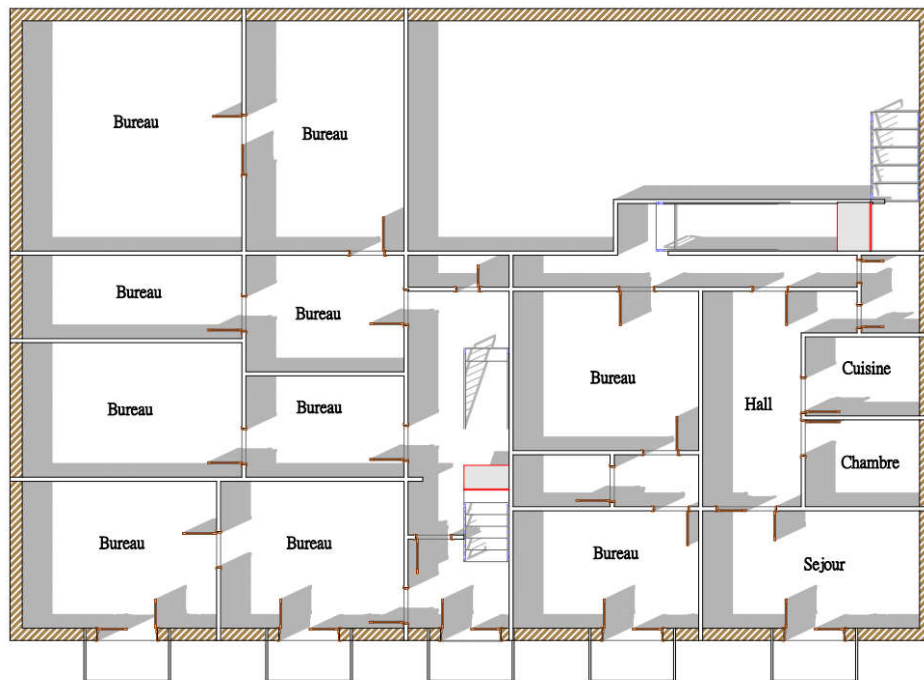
Plan premier étage, édifice colonial B4 (T2) au niveau de centre-ville de Tébessa.
